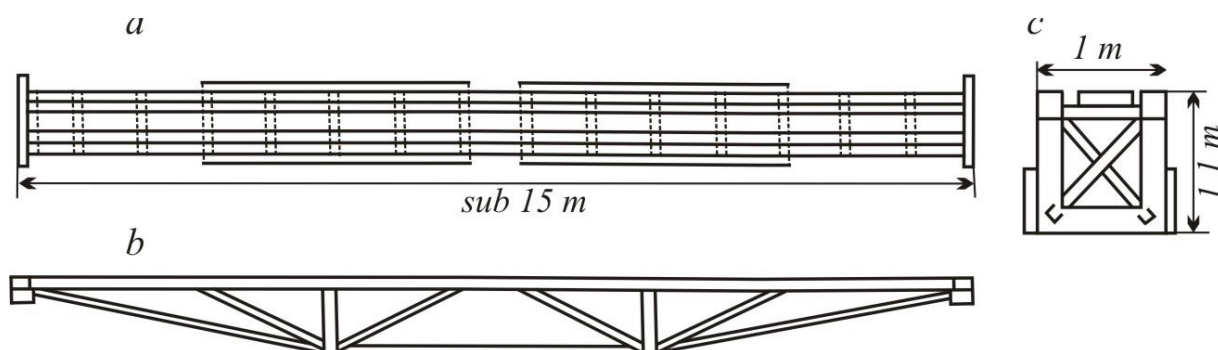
Punte transportabilă. a – plan, b – fațadă, secțiune transversală
